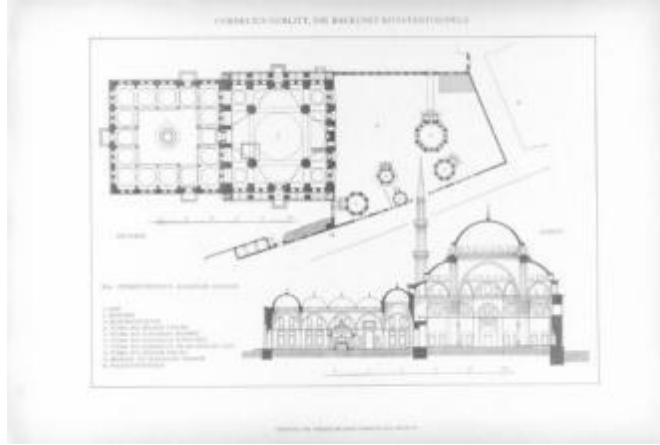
Fatih Cami ve Plan Şeması [29]
